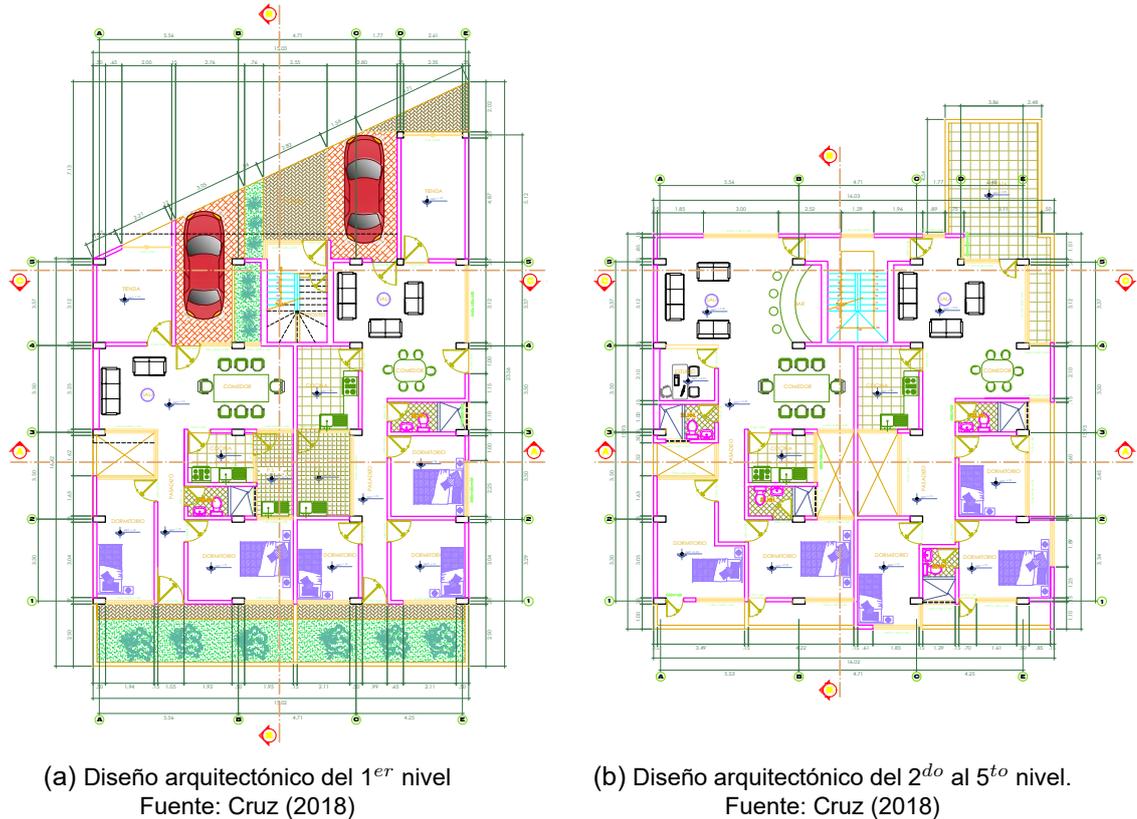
Diseño arquitectónico de la edificación con concreto vaciado in situ
